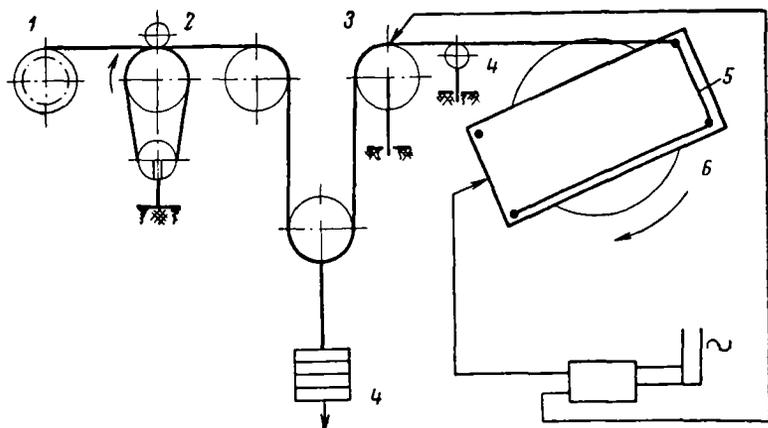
Непрерывное армирование с электротермическим натяжением:
